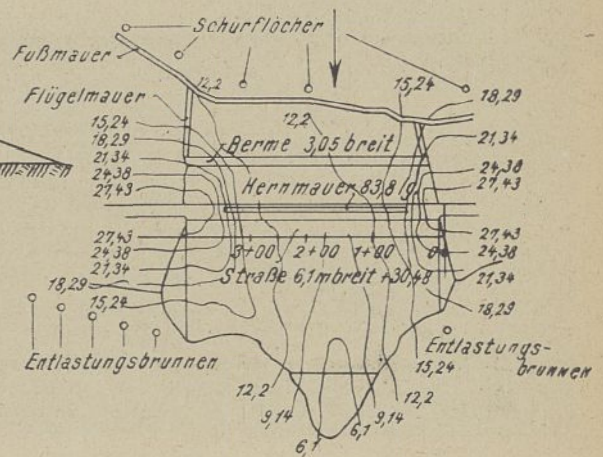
Grundriß der Auffüllung der Bruchstelle.
